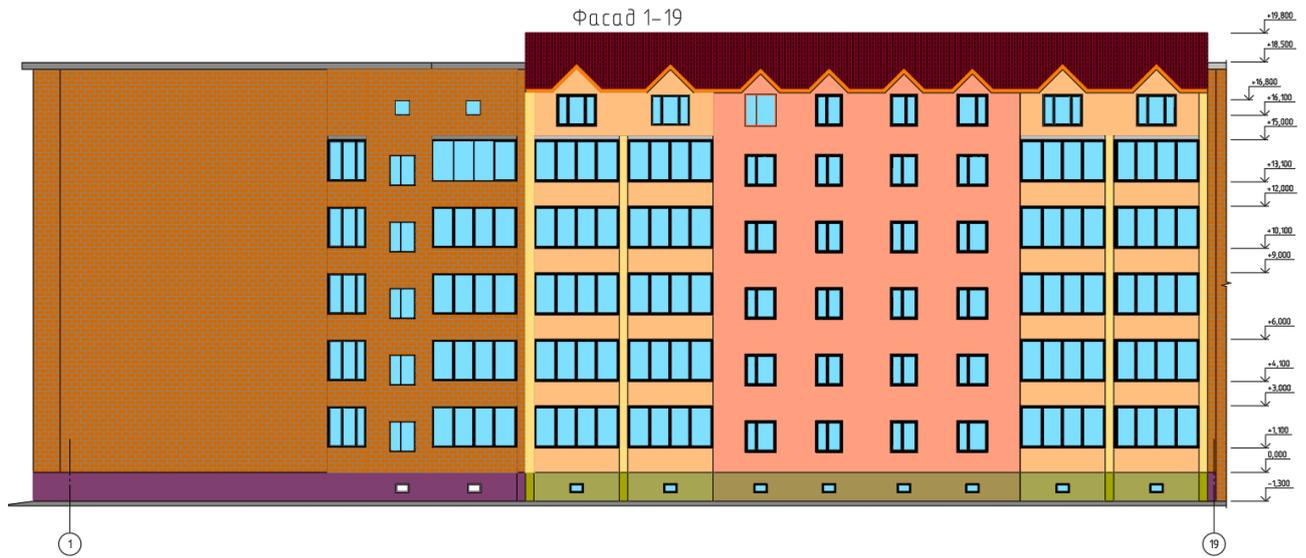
Оновлений фасад житлової секції багатоповерхової будівлі
